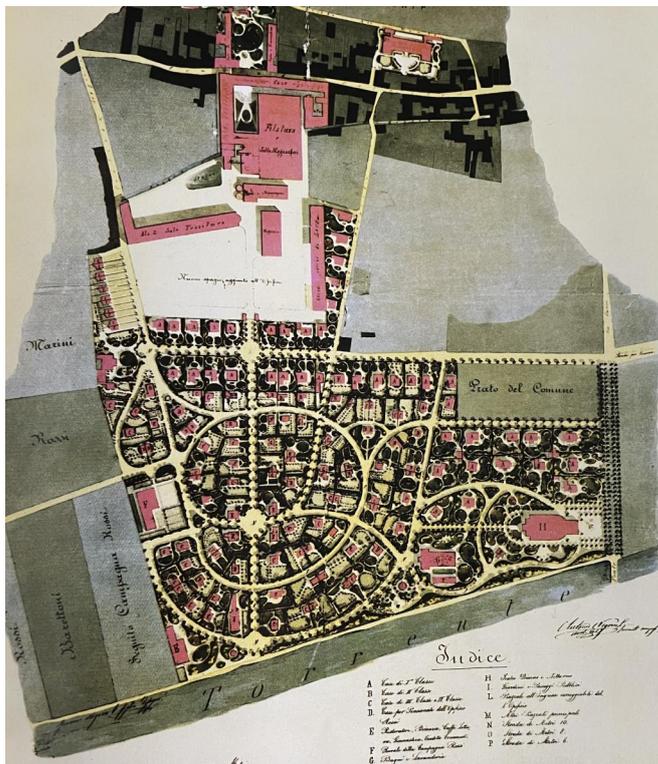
, Planimetria generale del progetto della Nuova Schio, A. Negri, *Villaggi operai*, p. 97.
